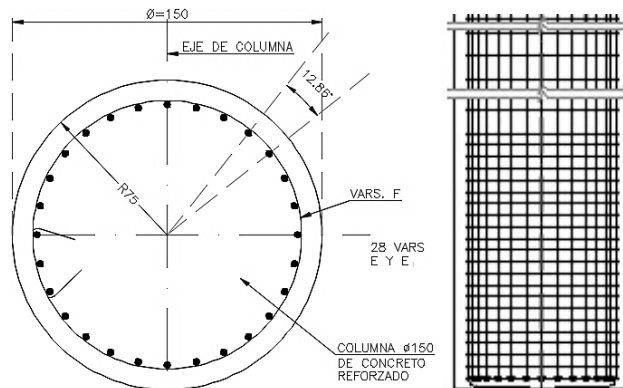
Dimensiones y armado de pila-columna en apoyo intermedio.
